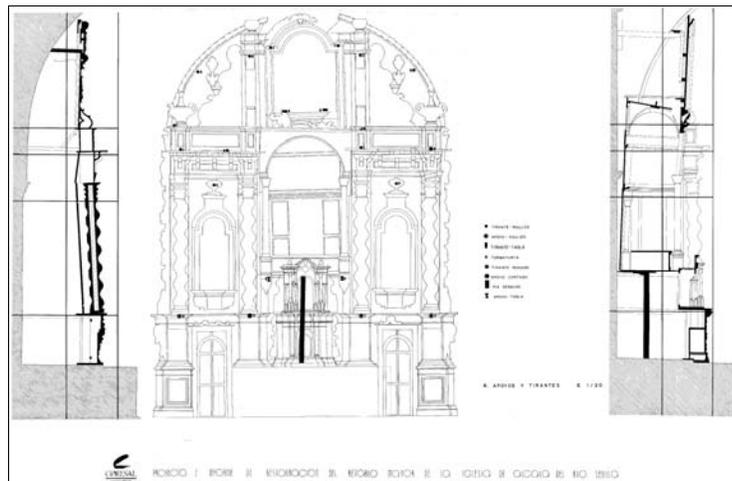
Levantamiento planimétrico y definición de elementos estructurales. Retablo Mayor de la Iglesia Parroquial de Alcalá del Río. Sevilla.
